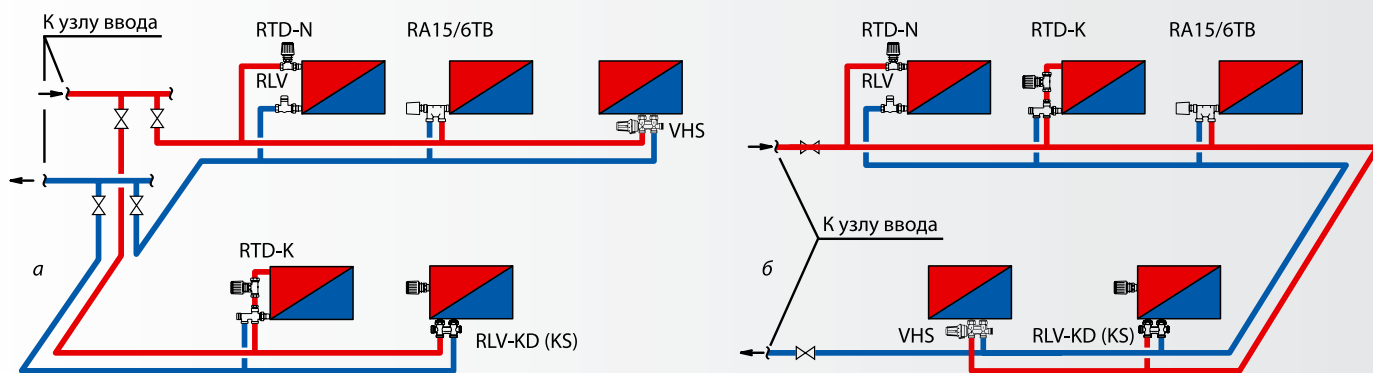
Двухтрубная периметральная разводка квартирных трубопроводов: а — тупиковая; б — попутная.
